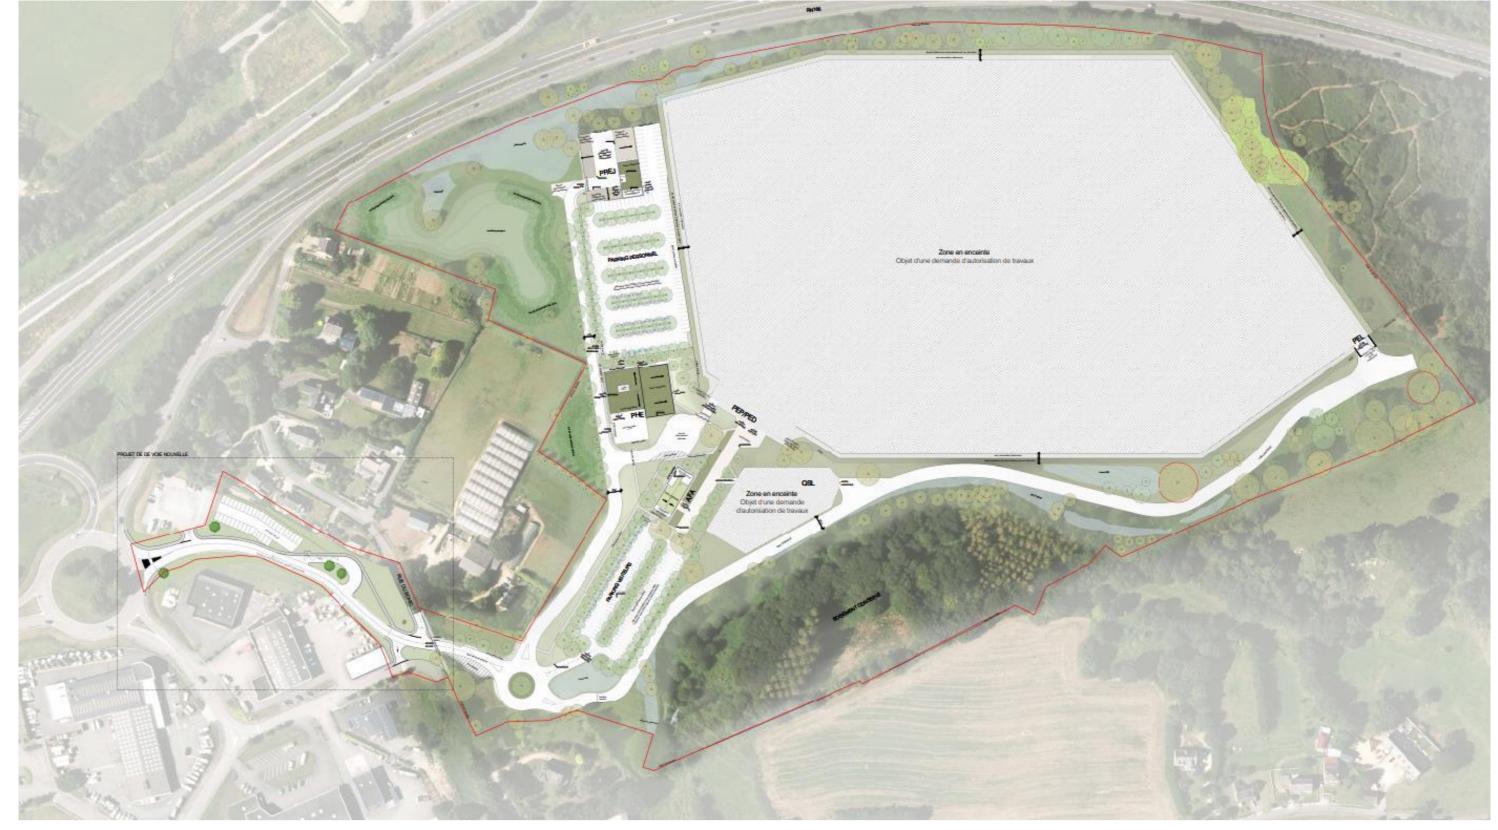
Plan masse du projet global (Source : GROUPE 6 Architectes)
